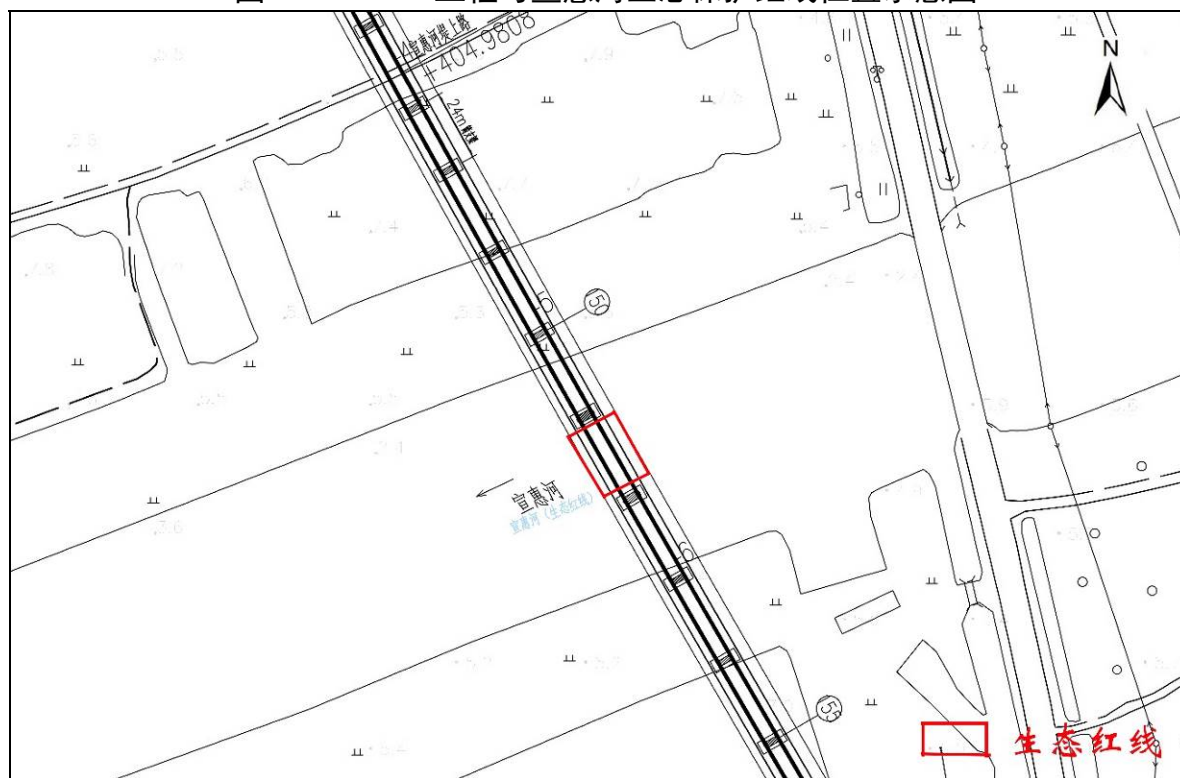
XI-7 工程跨越宣惠河桥梁及墩台平面布置示意图
